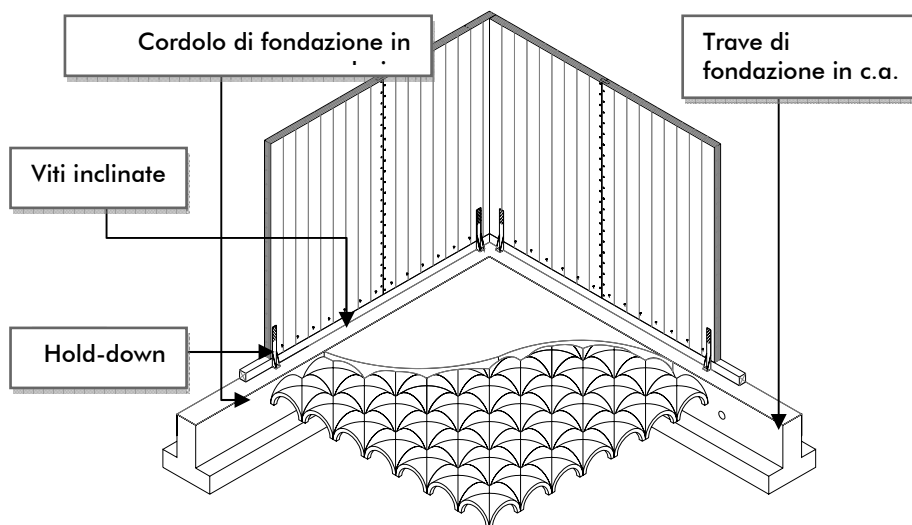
Collegamento alle fondazioni per un edificio XLam con cordolo di larice, tirafondi, viti e hold-down.
